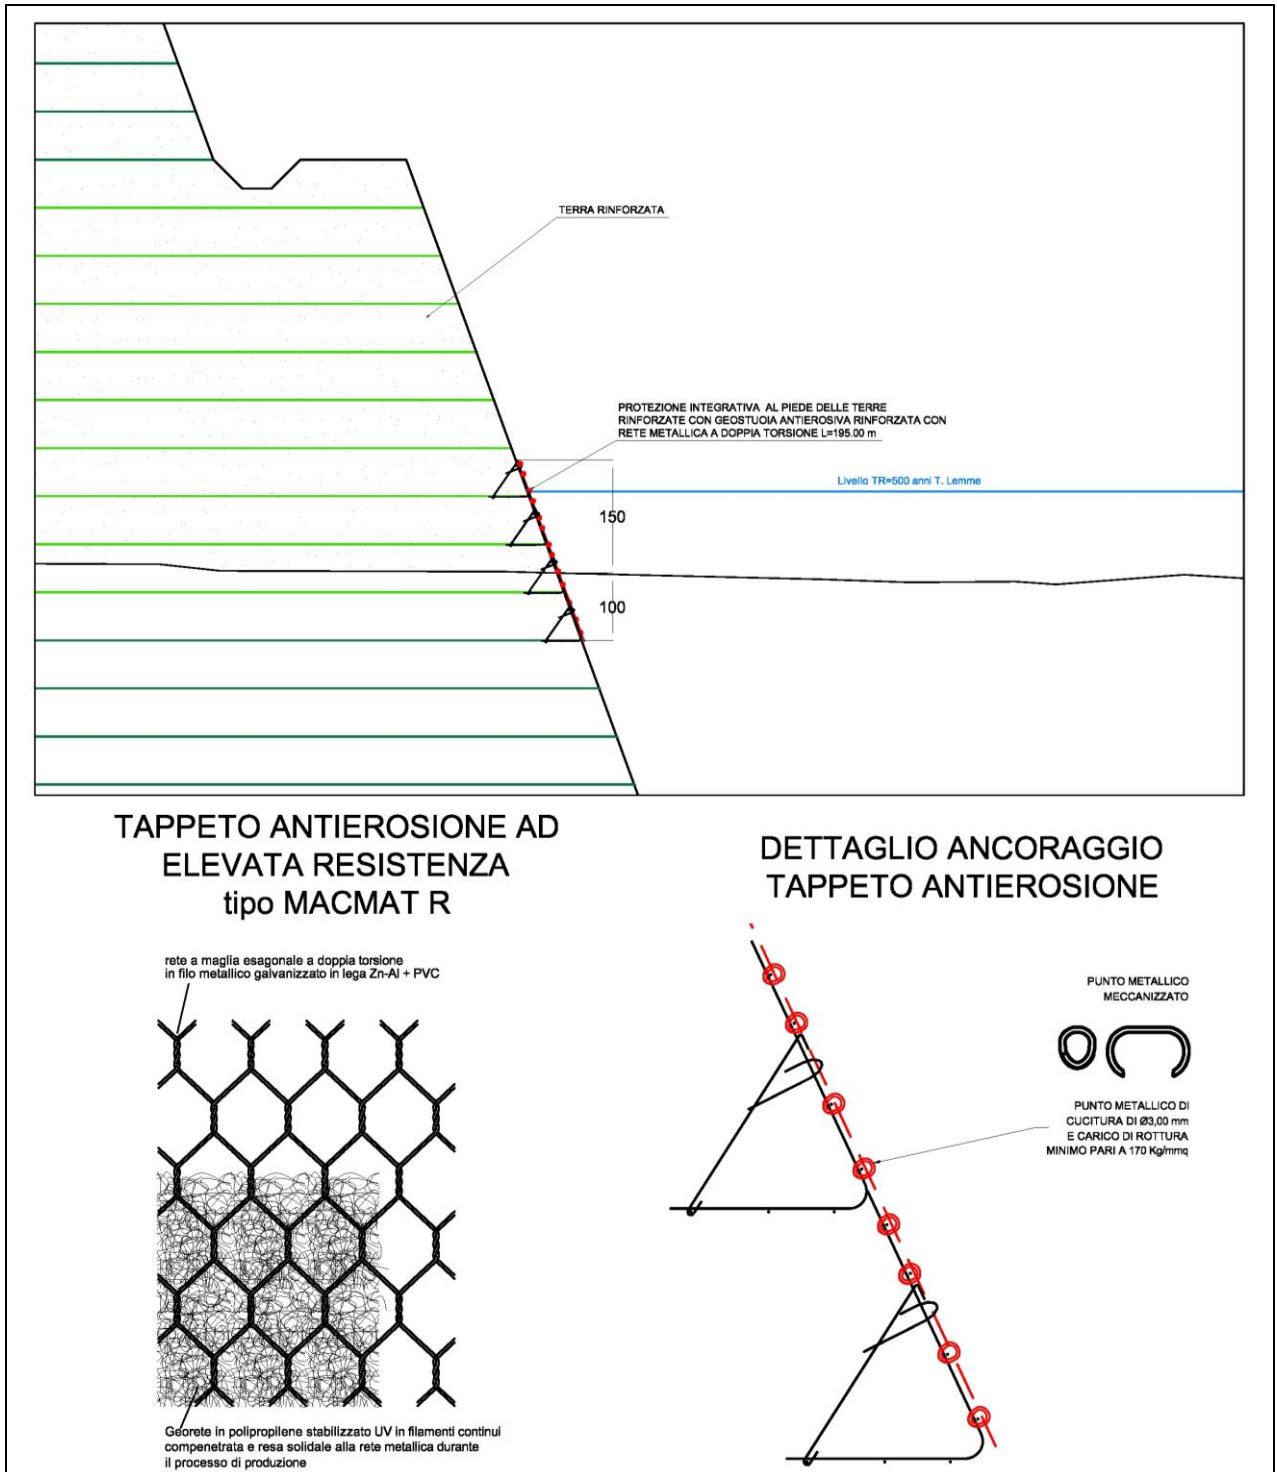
Sezione tipo protezione al piede delle terre rinforzate
